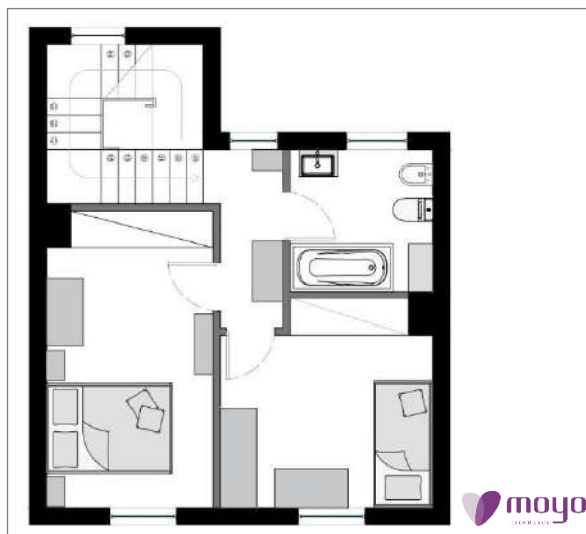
Planta original Cliente Privado (Piso 1) Sem escala
